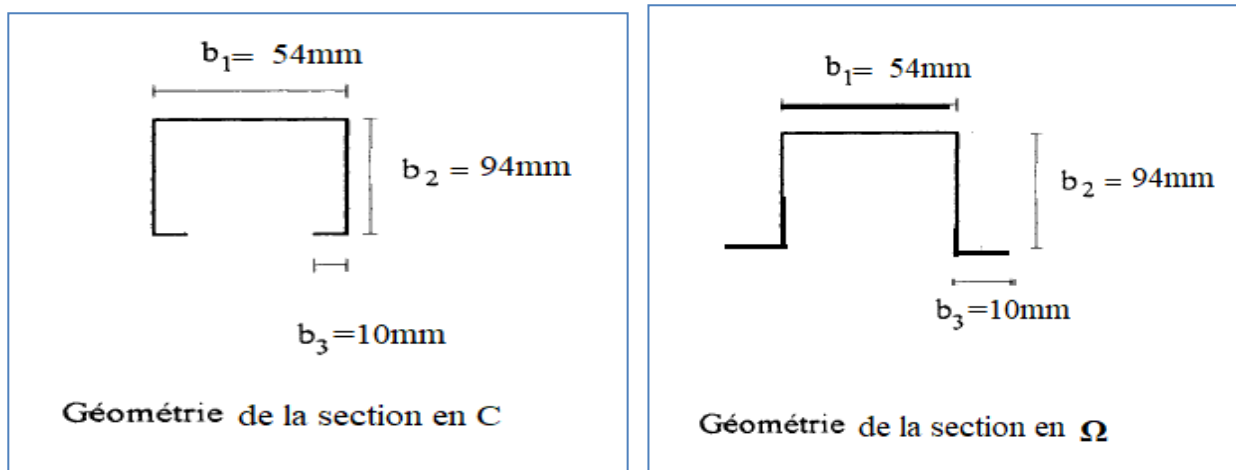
Les sections transversales des poutres de forme (C) et (Ω)
